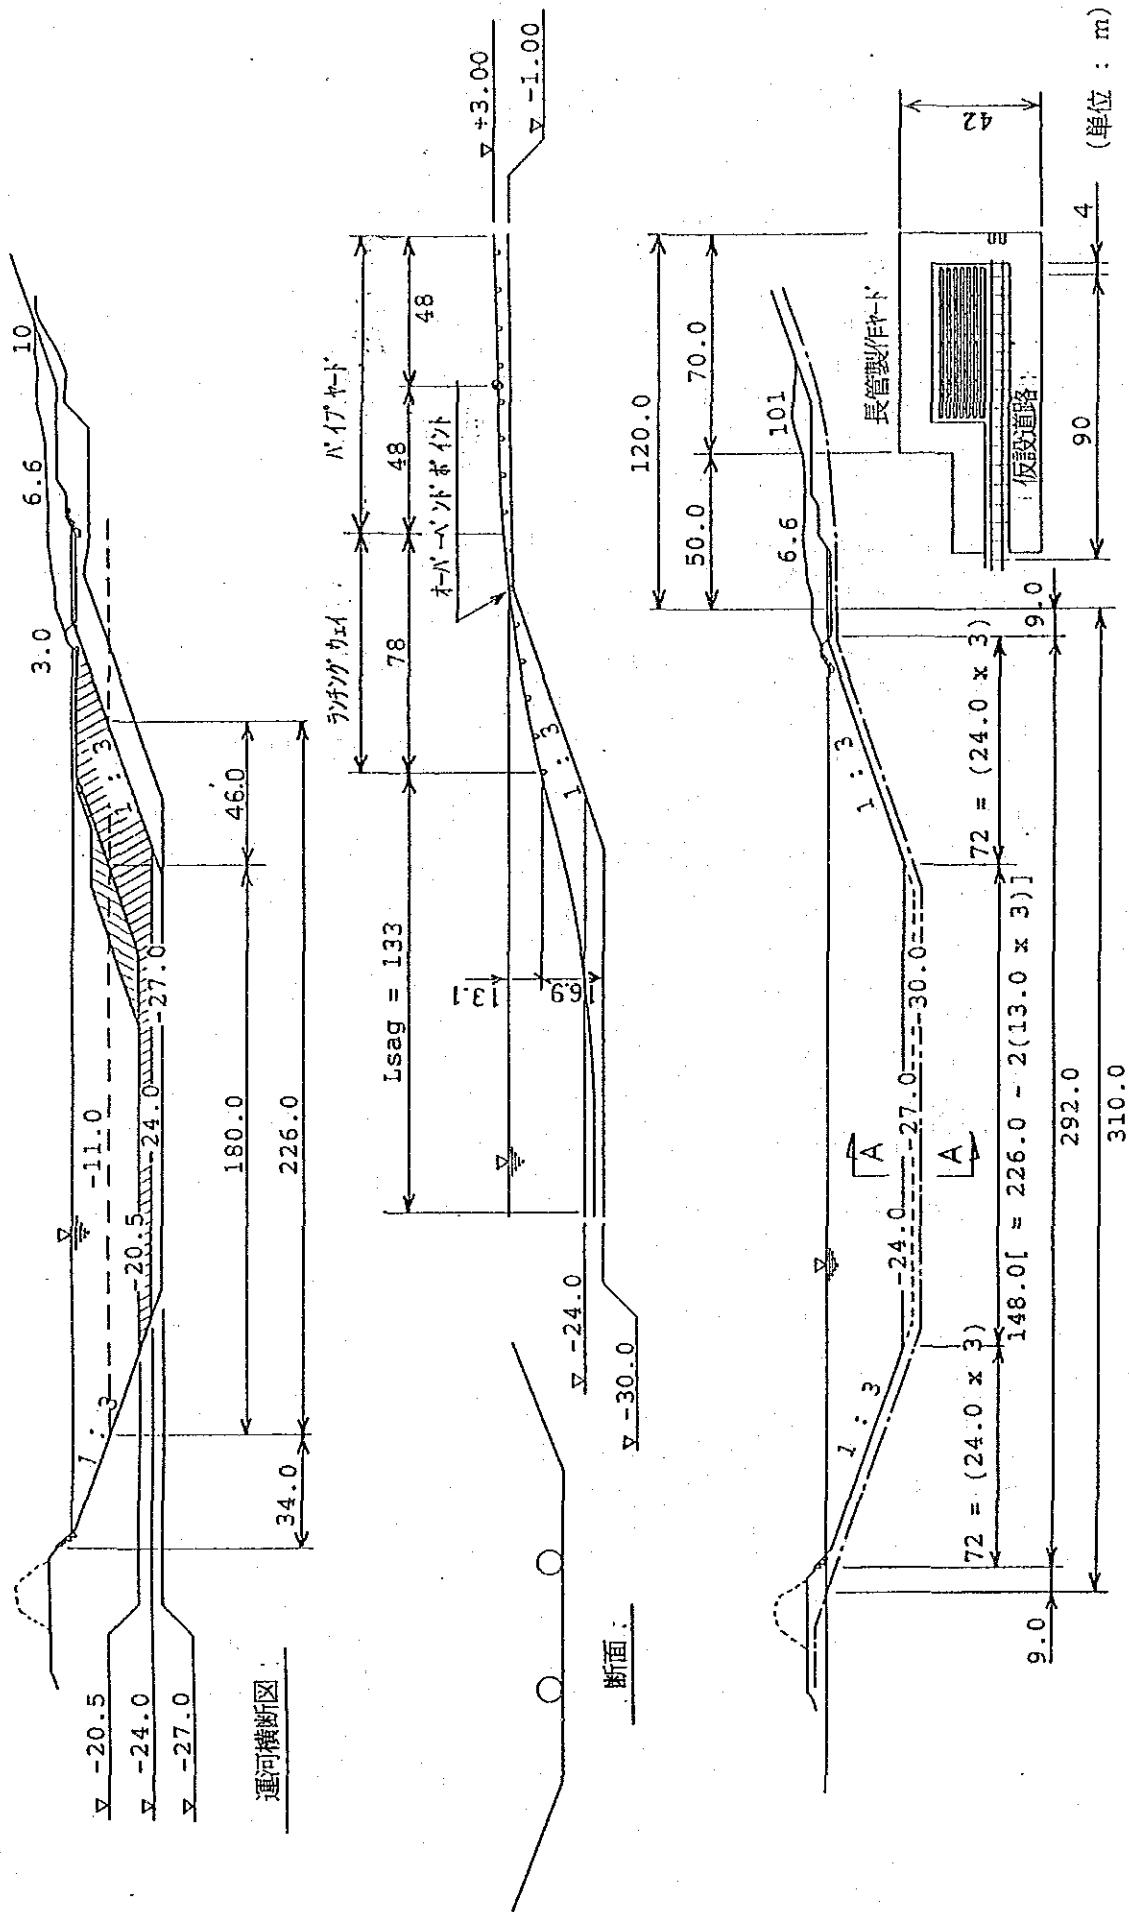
(2)-7 スエズ運河伏越橋断面図
